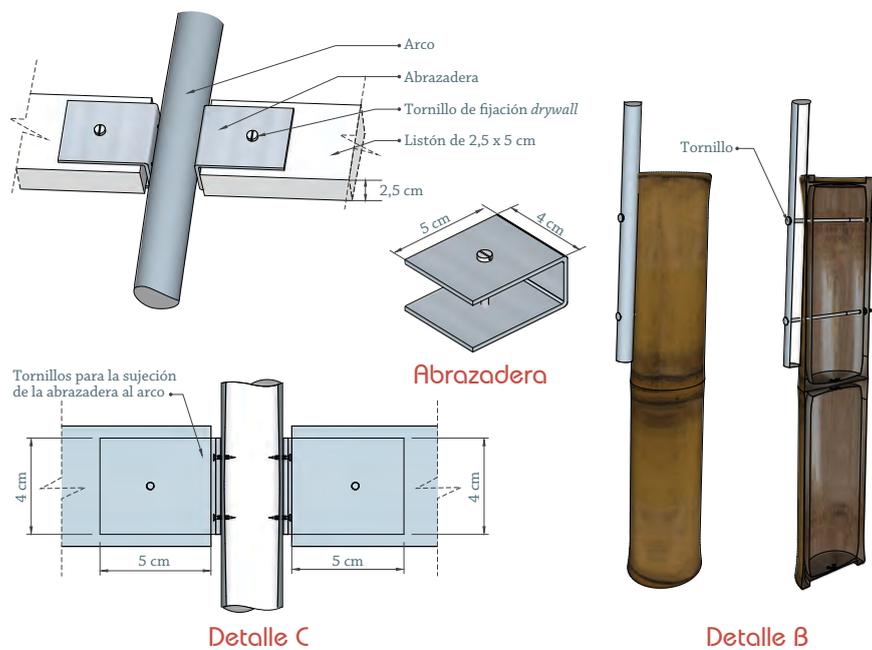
Detalle C, unión de listones a la estructura; Detalle B, unión de arcos metálicos a las columnas de guadua.
